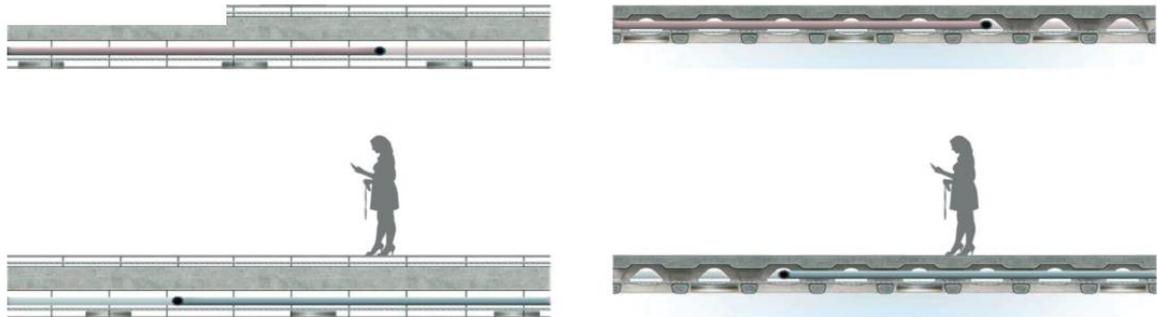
Posibles detalles ornamentales del sistema constructivo.
